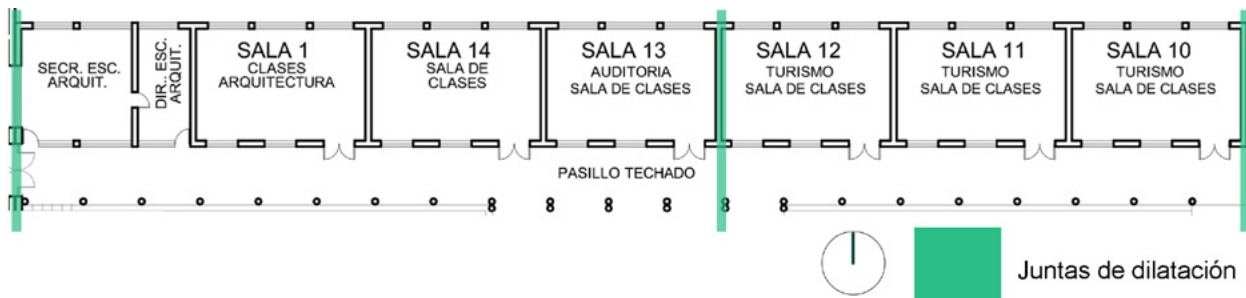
Planta arquitectura bloque E. Fuente elaboración propia.
